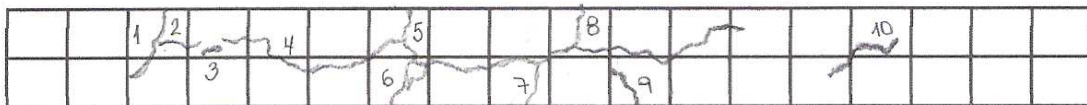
Fisuras observadas en la viga 12.
